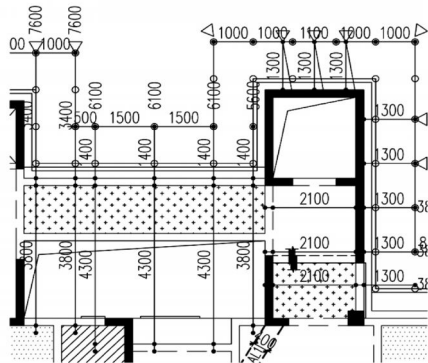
连廊部位悬挑脚手架工字钢及钢管布置平面图
